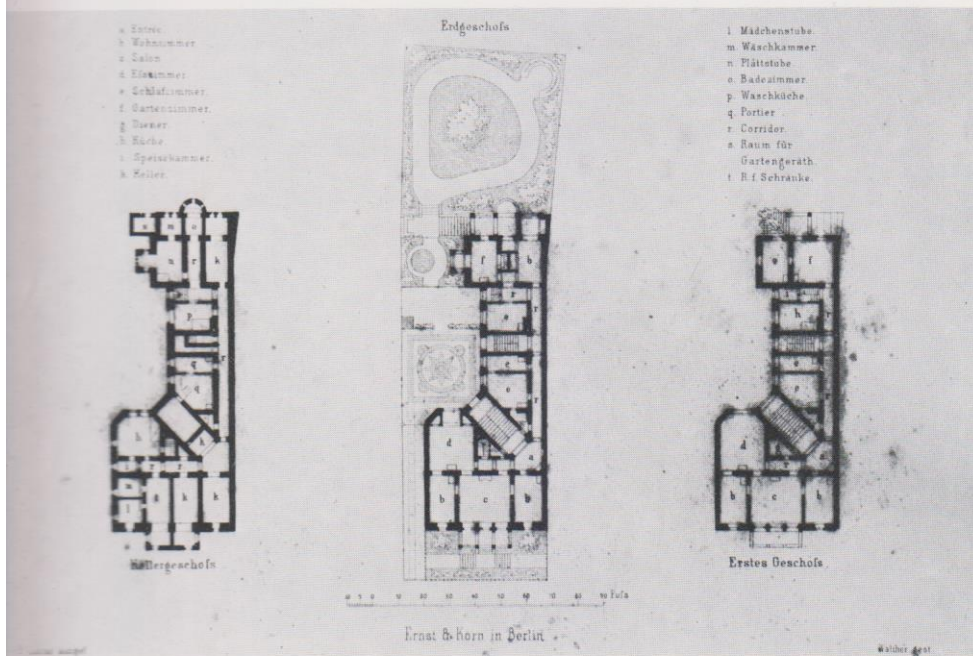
Victoriastr. 31, R. Lucae, 1856-57, Grundrisse.
